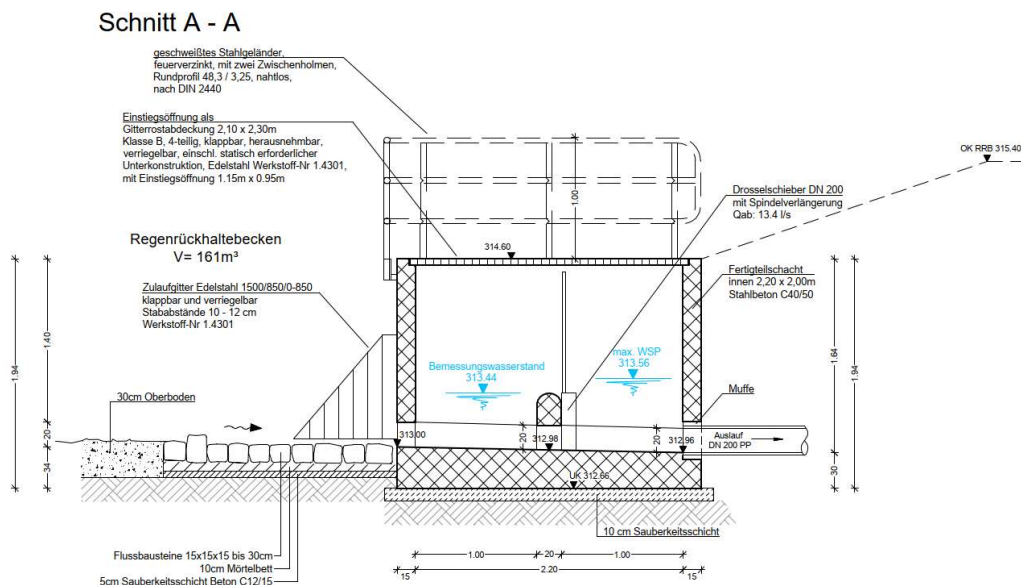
Drosselbauwerk siehe Detailplan E10
